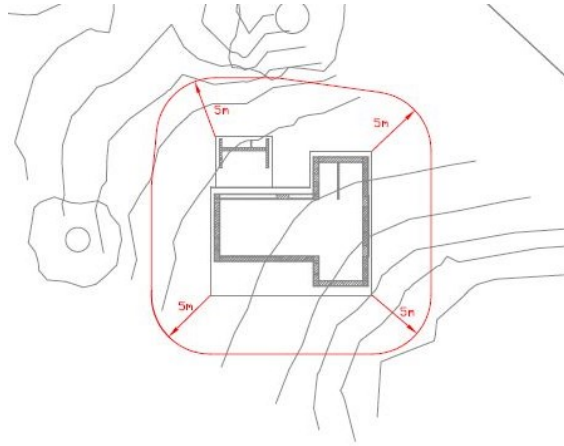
Separación a linderos (sin escala). 2016. Editado de plano topográfico.
